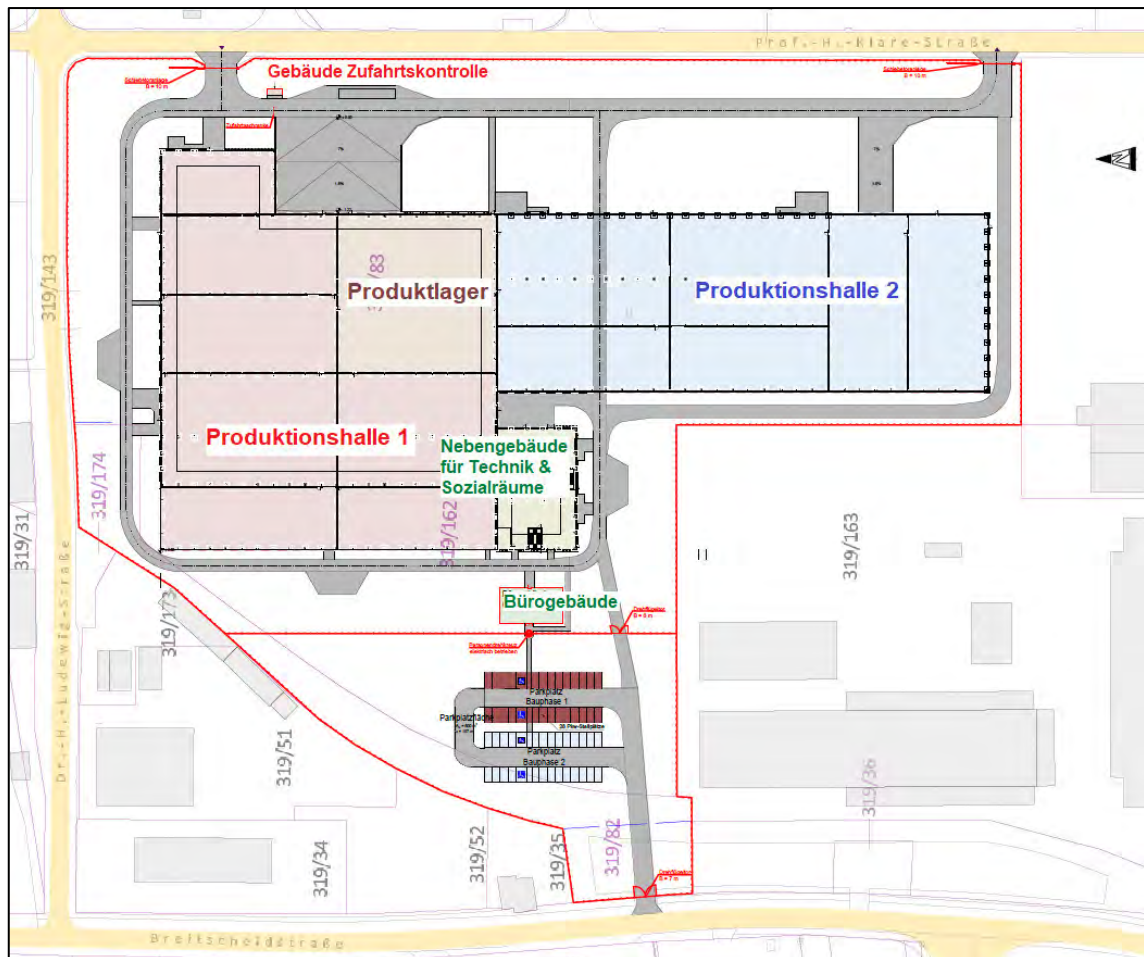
Lageplan (rote Umrandung – Einfriedung Vorhabenfläche)
